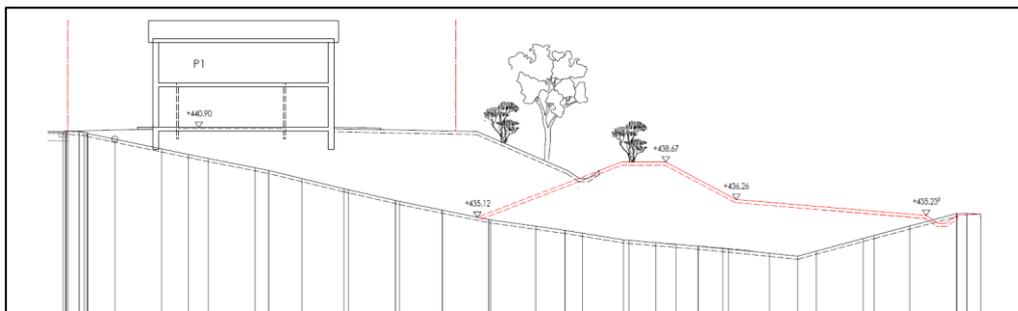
Geplanter Geländeverlauf mit Lärmschutzwall
